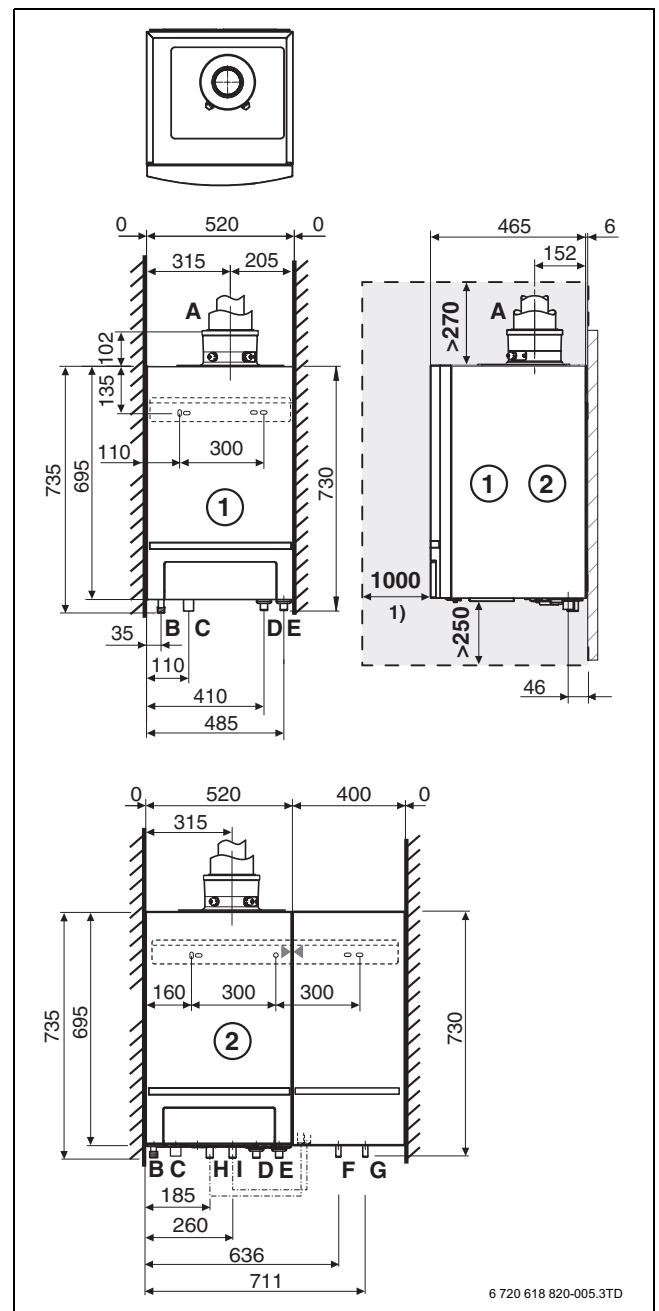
Abmessungen und Anschlüsse (Maße in mm)
